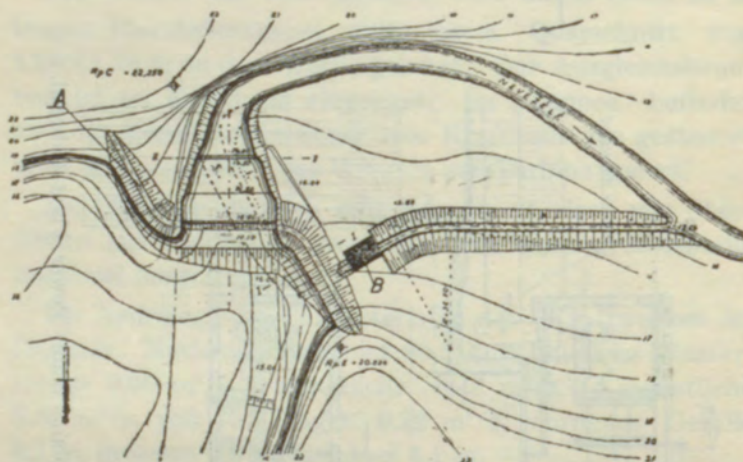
Wasserkraftwerk Gabrelai — Lageplan. Water Power Plant Gabrelai — Plane.
